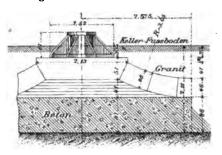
Gründung der Säulenreihe im Worldgebäude in New York. M. 1:100.
